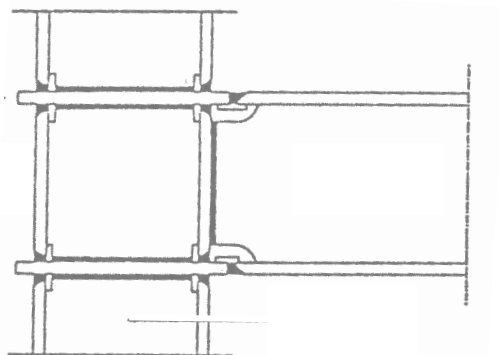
Schema di collegamento trave-colonna, adottato in Giappone
